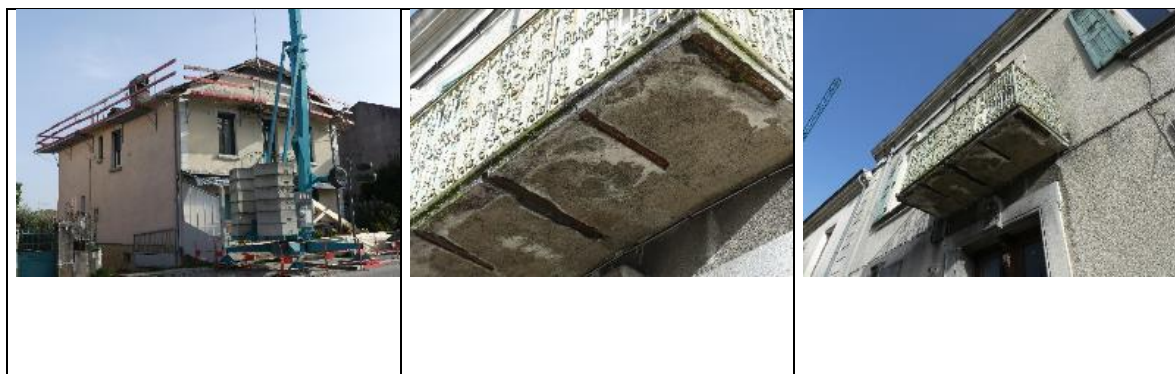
Exemple de construction typique de l'héritage Lafarge et de balcon.
